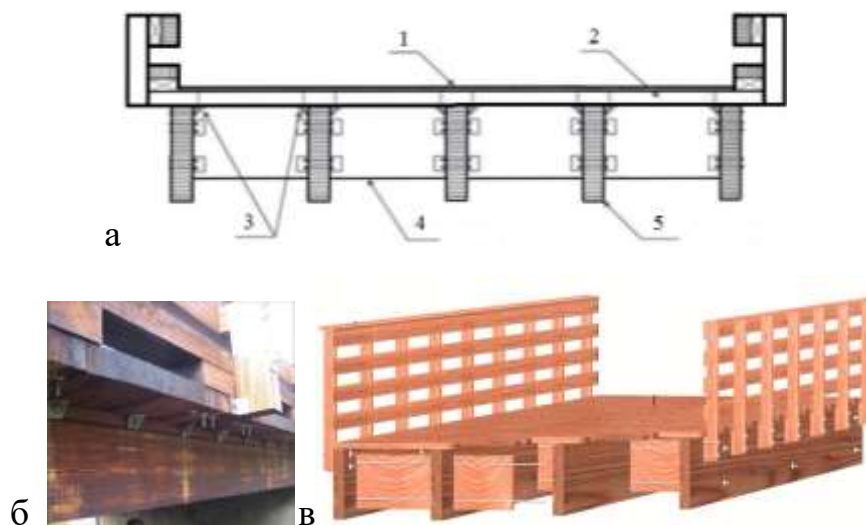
Ребриста прогонова будови: а – конструкція; б, в – вигляд; 1 – асфальтобетонне покриття; 2 – поперечна дерево-плита; 3 – з'єднувальний елемент; 4 – діафрагма; 5 – клеєна балка
